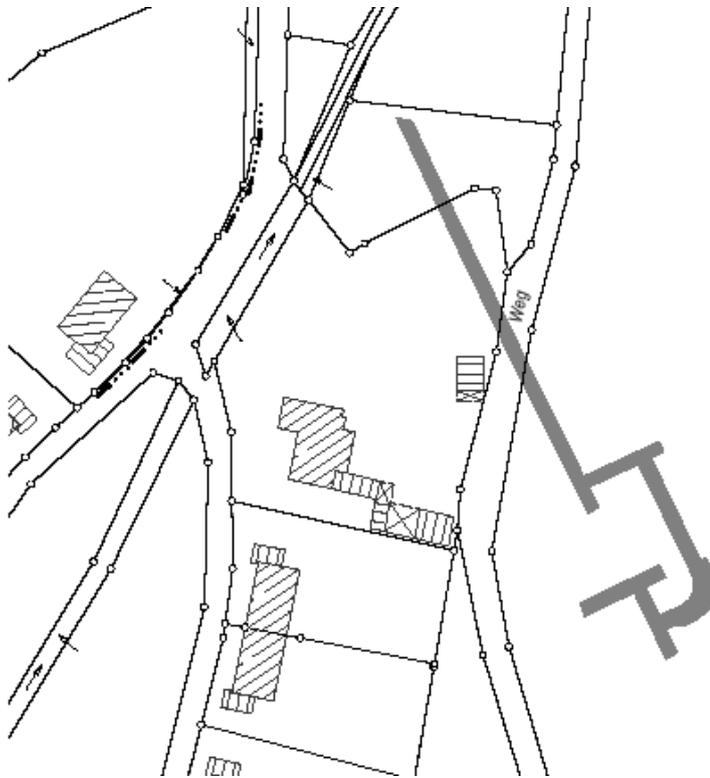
Lageplan Luftschutzstollen WALDRING
